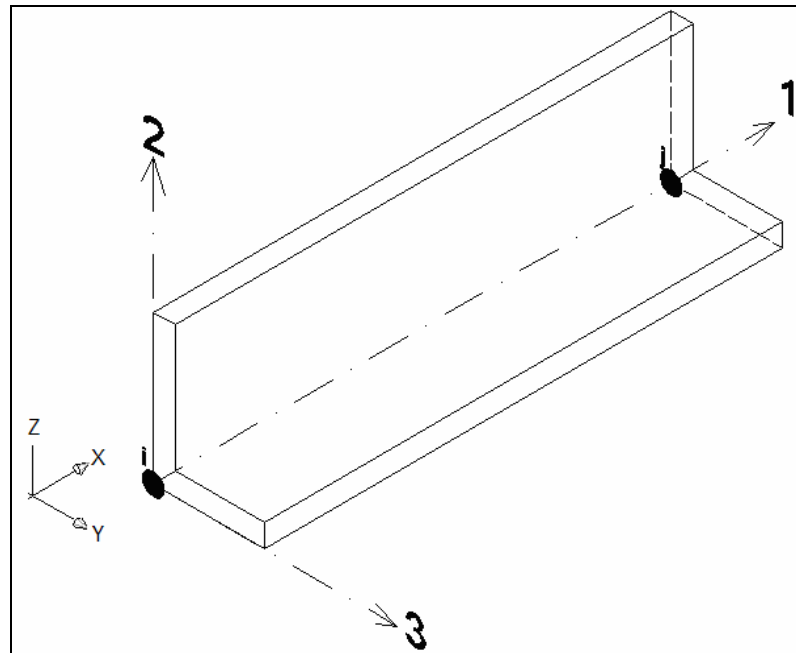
Ejes locales para un elemento (FRAME) longitudinal
